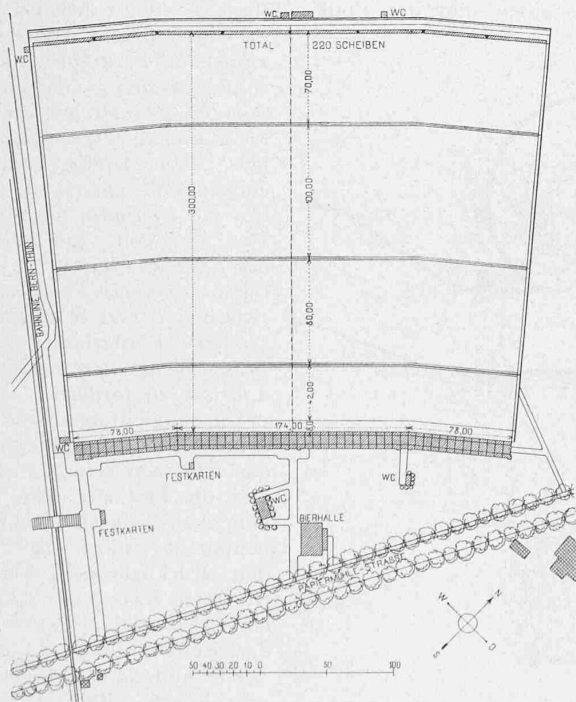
Lageplan der Schiessanlagen. — Masstab 1 : 5000.
